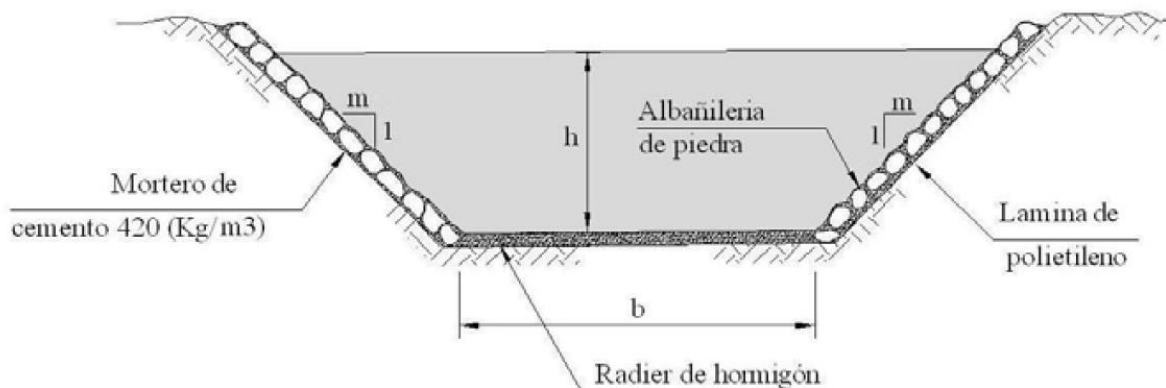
Sección típica de canal con albañilería de piedra y base de hormigón (Mery M., 2013).
